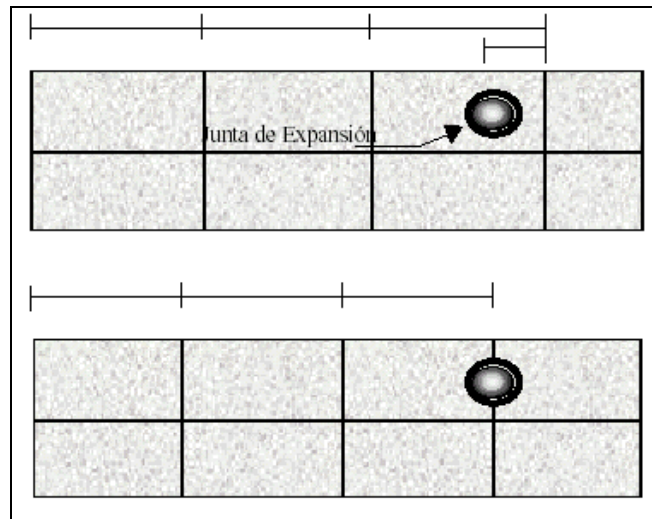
Modulación de Losas del Pavimento Rígido con Presencia de Estructuras Hidráulicas
